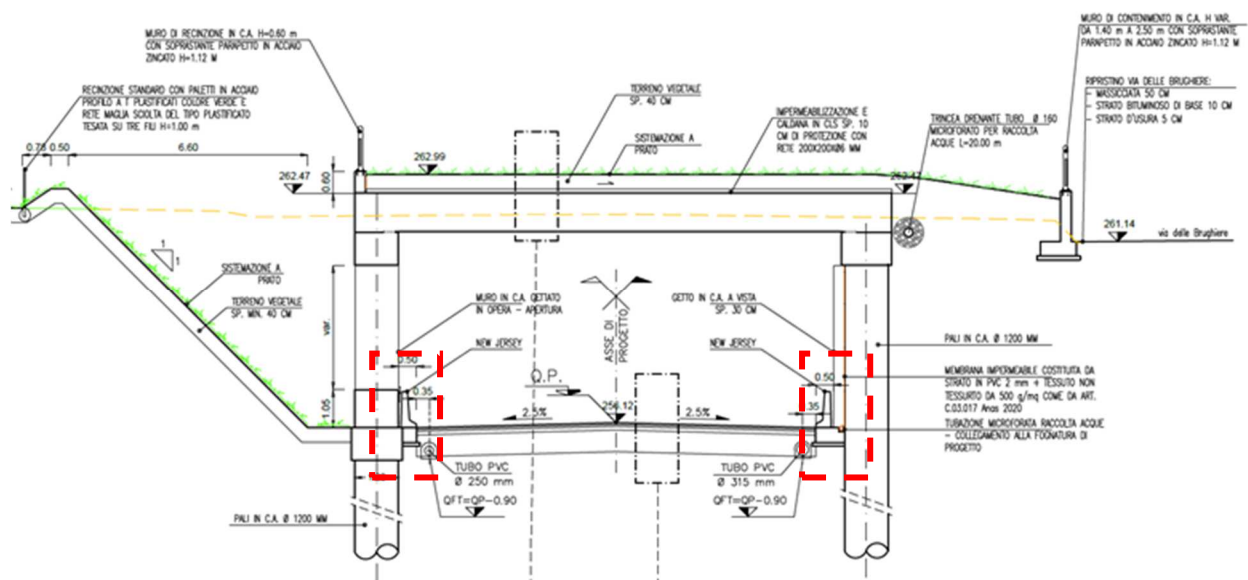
New Jersey a protezione degli elementi della galleria finestrata
